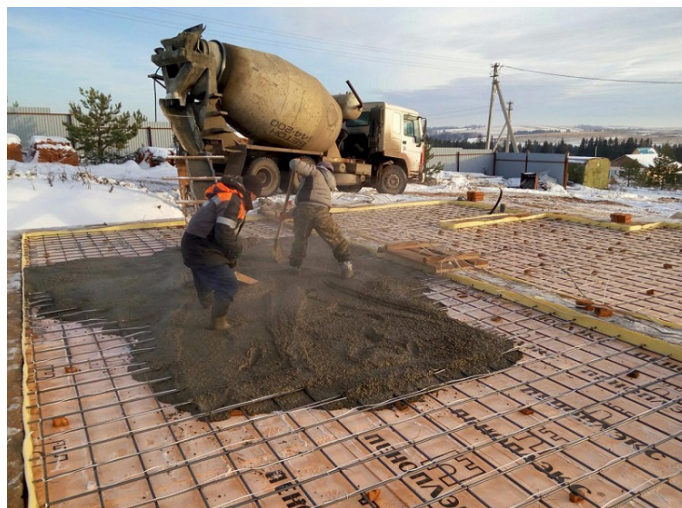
Бетонирование фундаментной плиты в зимних условиях.
